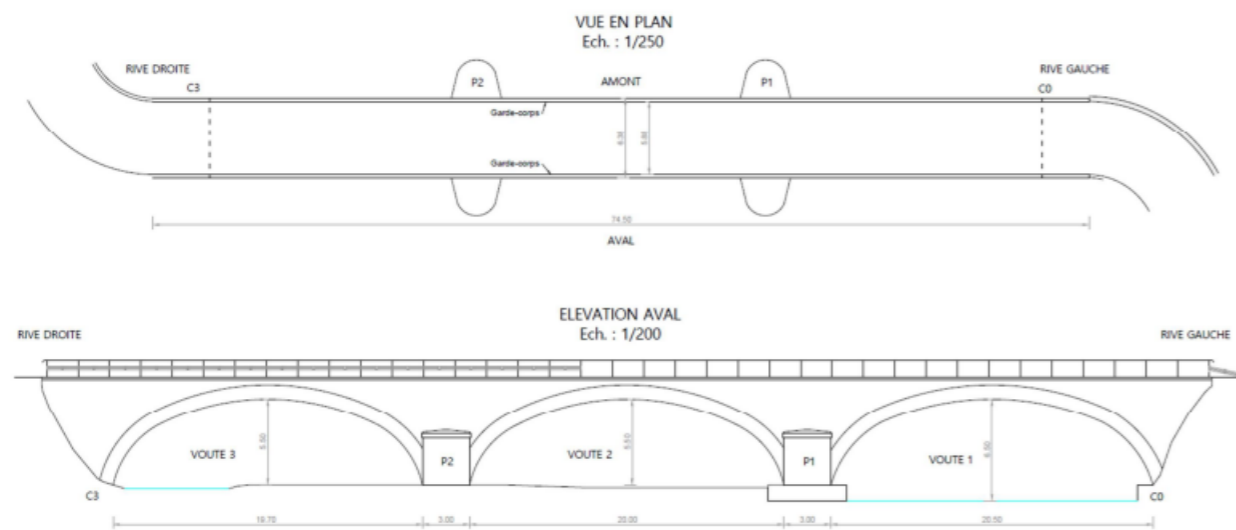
Vue en plan et élévation aval du pont de la Trinité existant (source : Arcadis)
